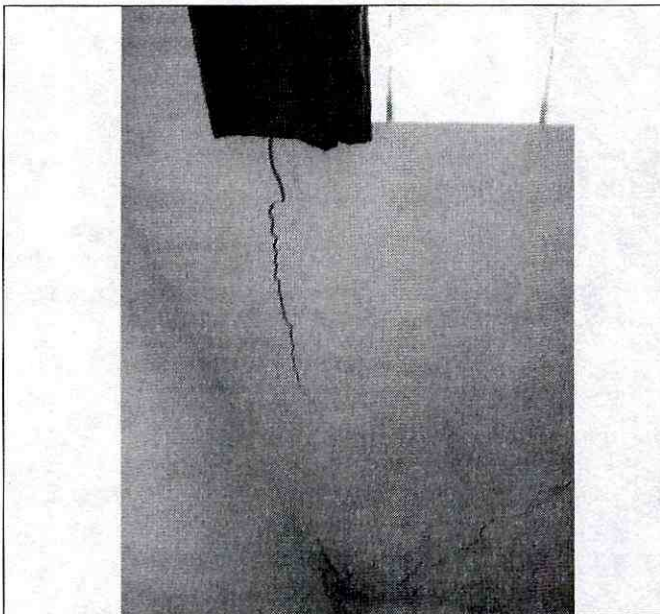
Se observan las grietas de tendencia vertical sobre el muro de cerramiento del cuarto principal de la parroquia.
